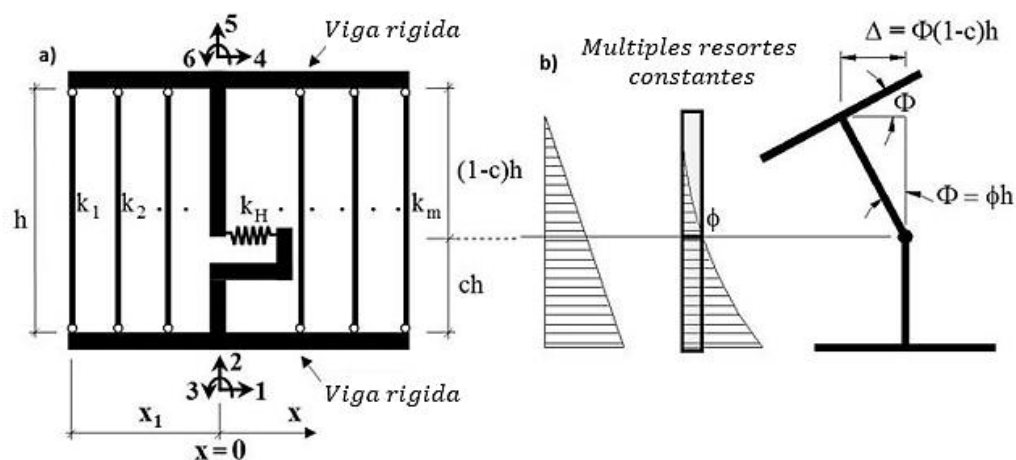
MVLEM Modelado de muros en concreto reforzado.
